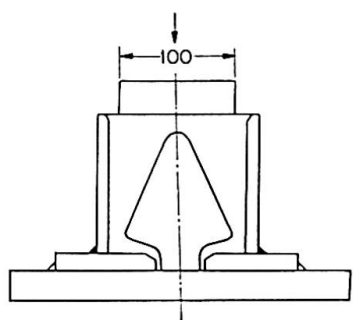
Vertikale Belastung mittig (Versuchsanordnung).
